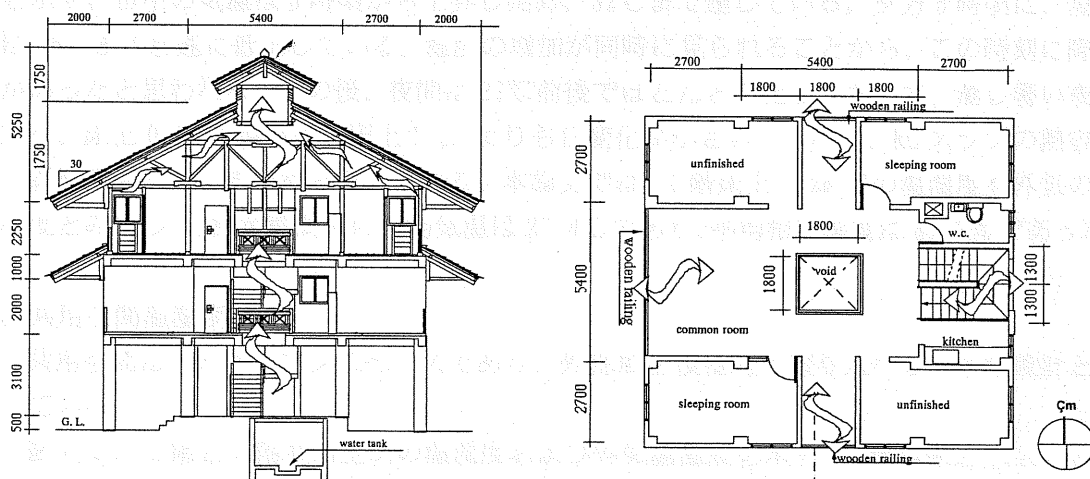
(左) 建物中央南北方向断面図 (右) 2階平面図
